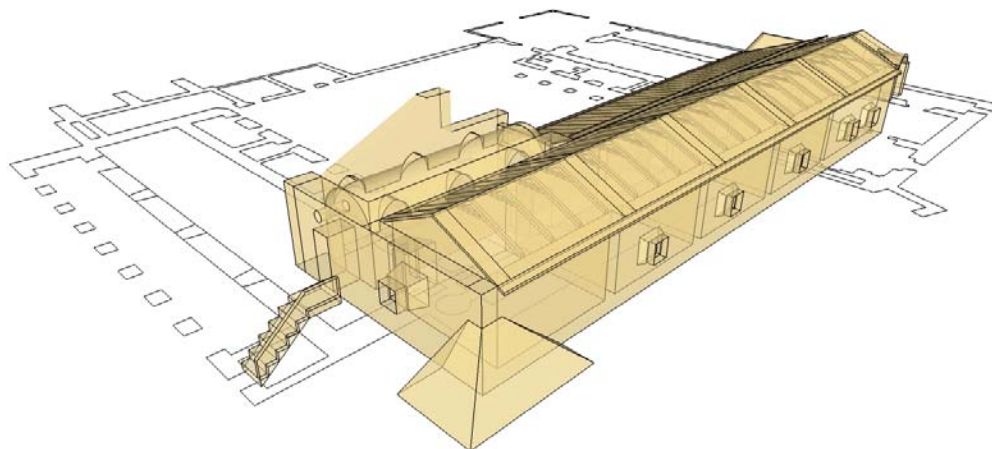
Reconstrucción Virtual Sector 2 b: Ala Oeste Planta Alta.
